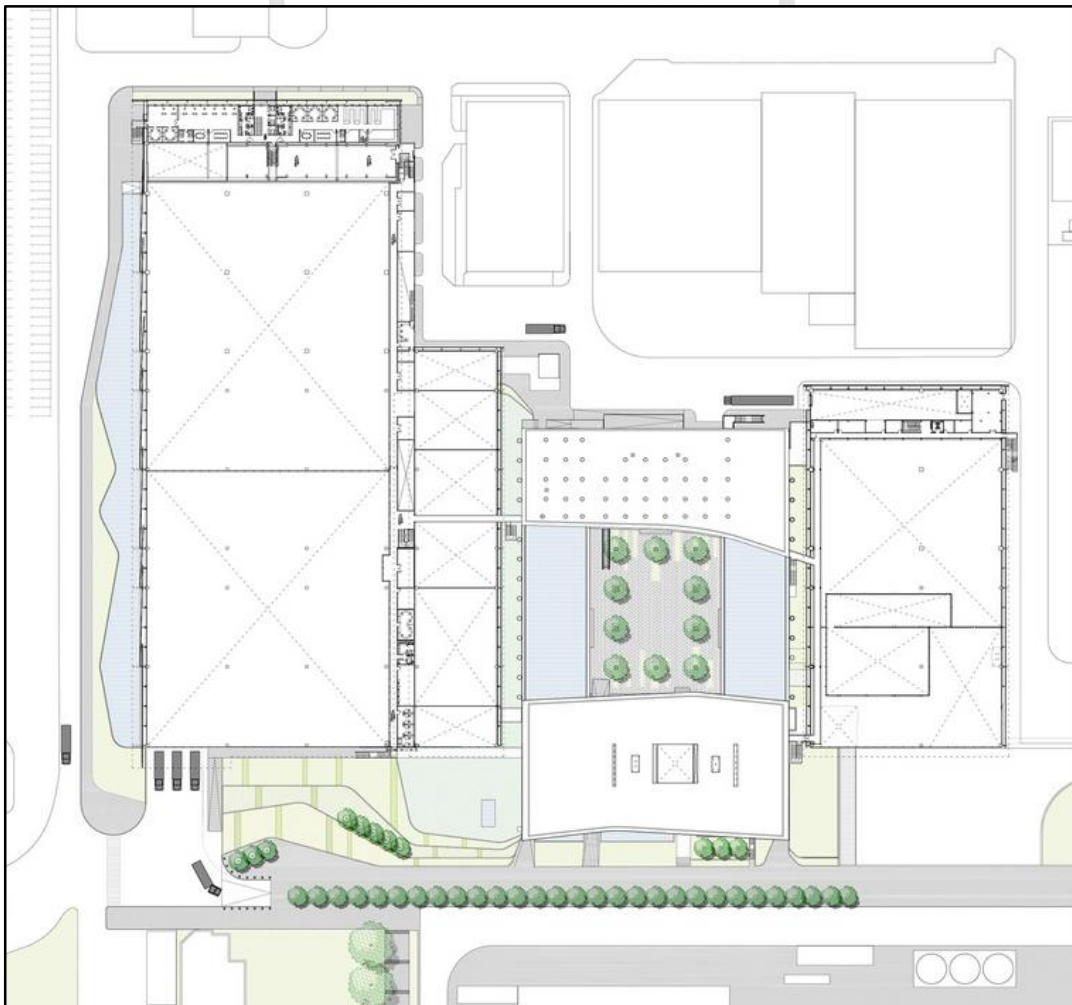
Plot plan de la fábrica Carozzi Fuente: archdaily.pe
